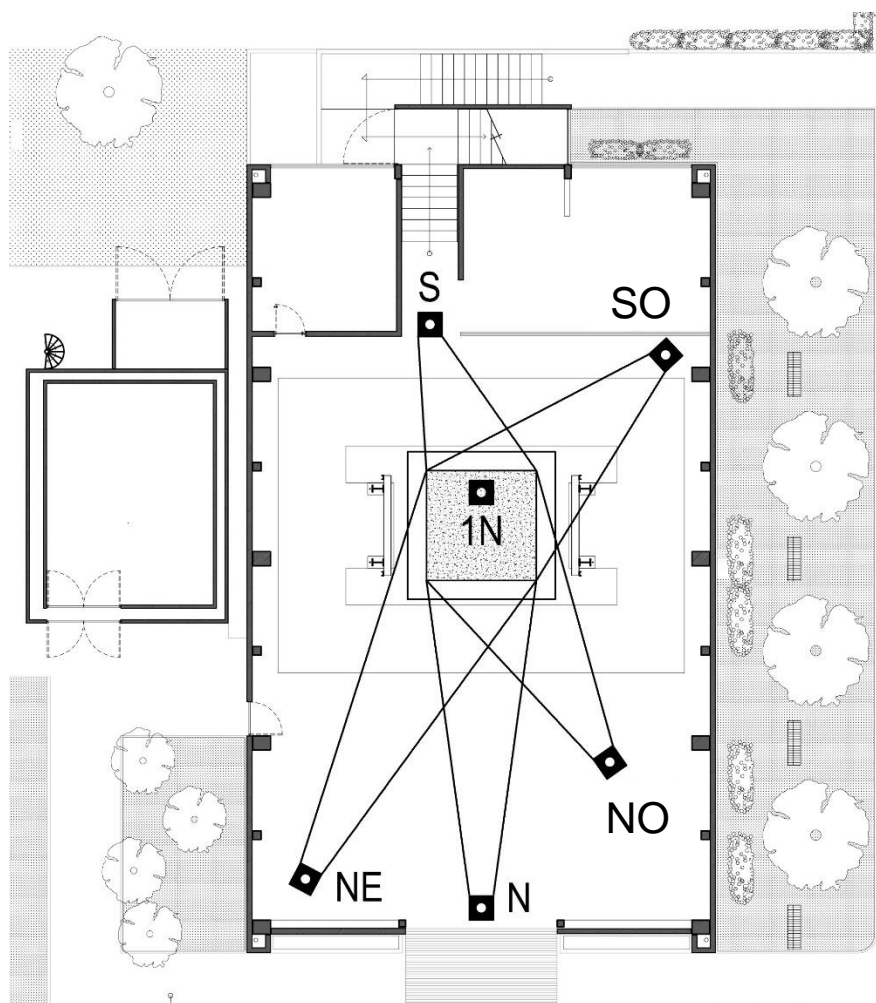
Ubicación de cámaras de video en la planta baja de la MV-II UNAM
